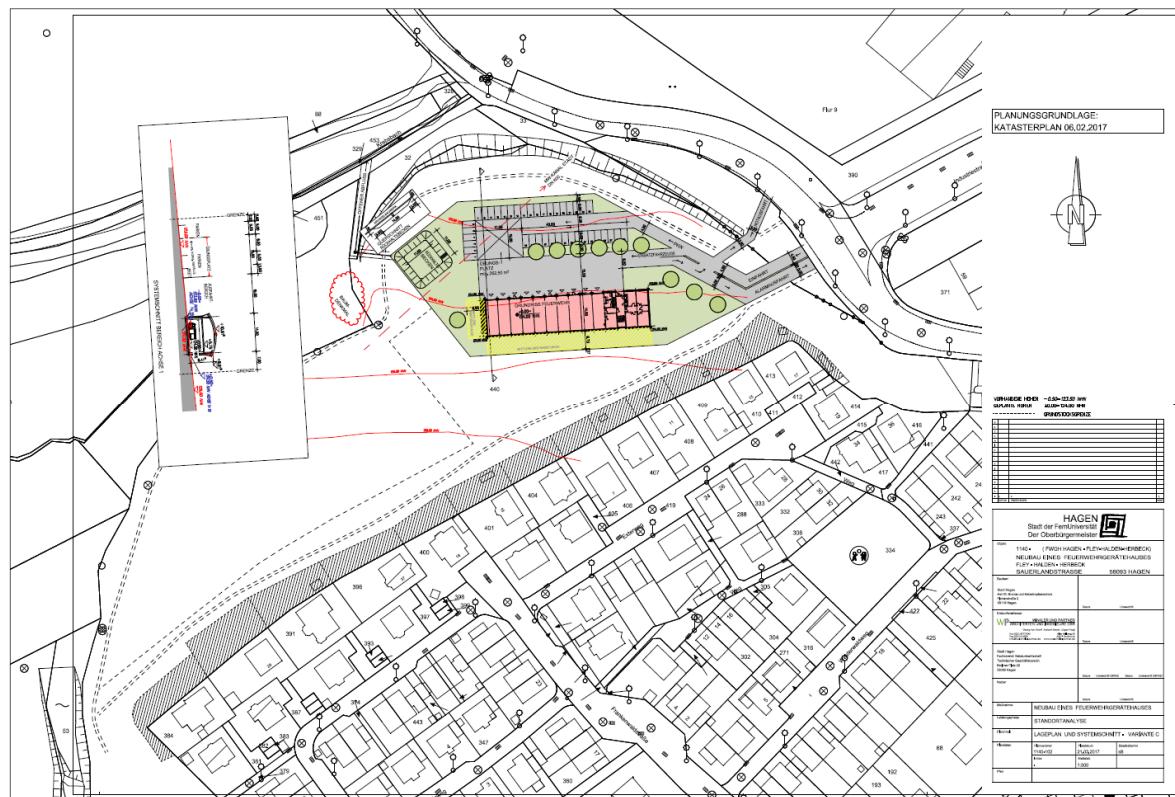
Lageplan und Systemschnitt – Variante C des Feuerwehrgerätehauses [7]
